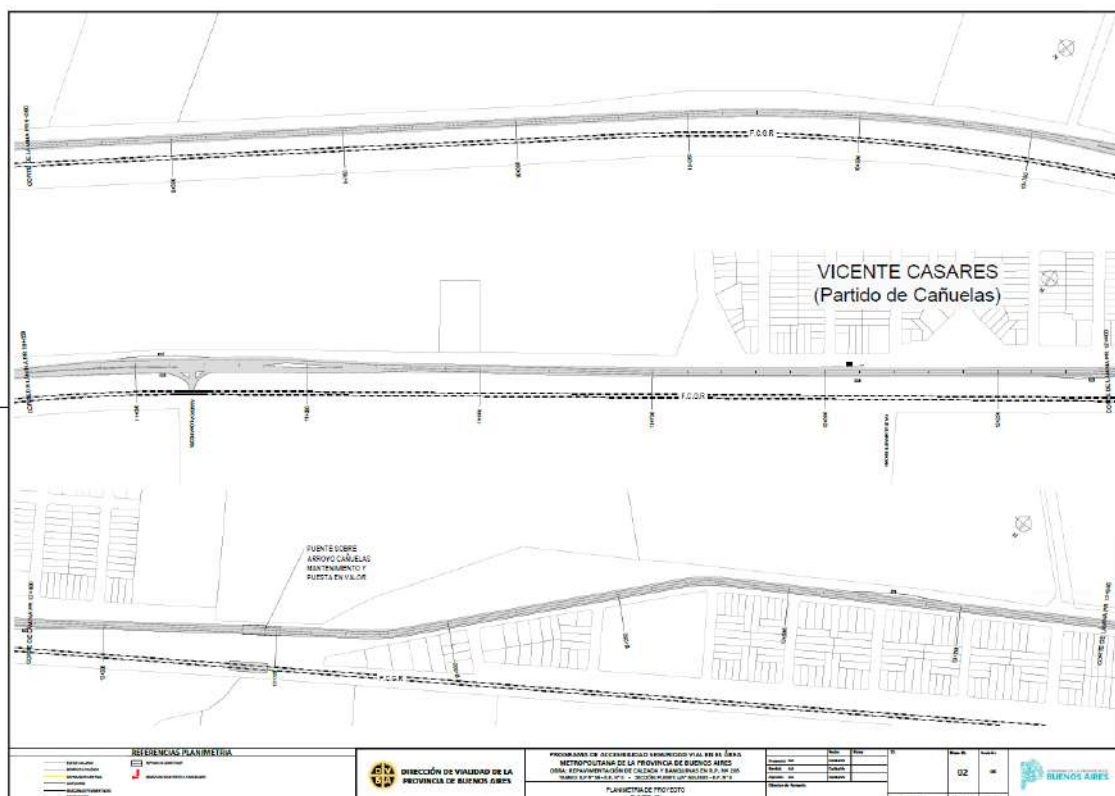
Planimetría de Proyecto RPN°205 (3)
